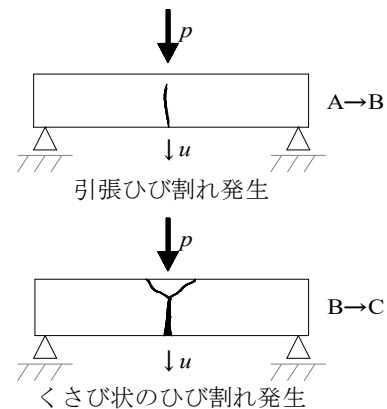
無筋コンクリートの曲げひび割れ
